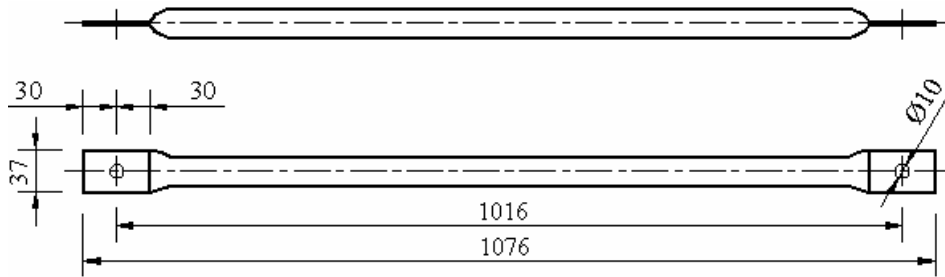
Diagonal - detalhe do amassamento e furação (mm)
